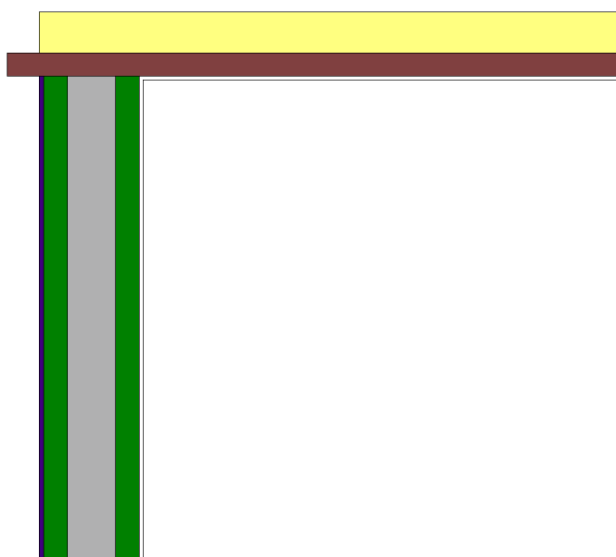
Liaison Bloc ISOLASUP Evolution / Plancher haut léger au niveau de la façade
